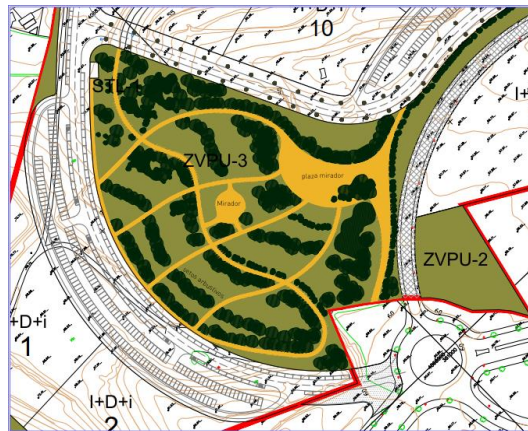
Plano Ordenación Orientativa Zonas Verdes
